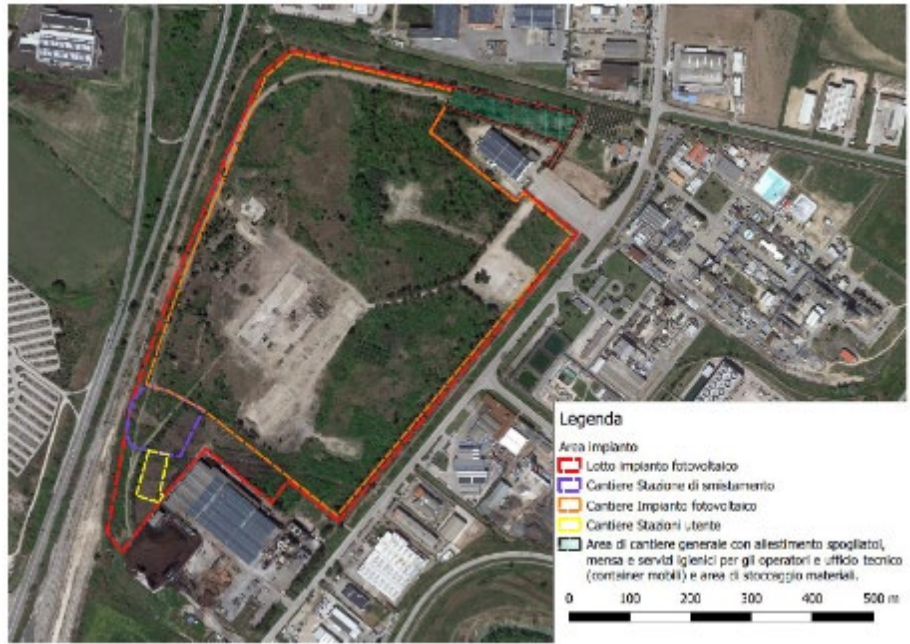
Aree di cantiere (cfr. Elab. B.16)
